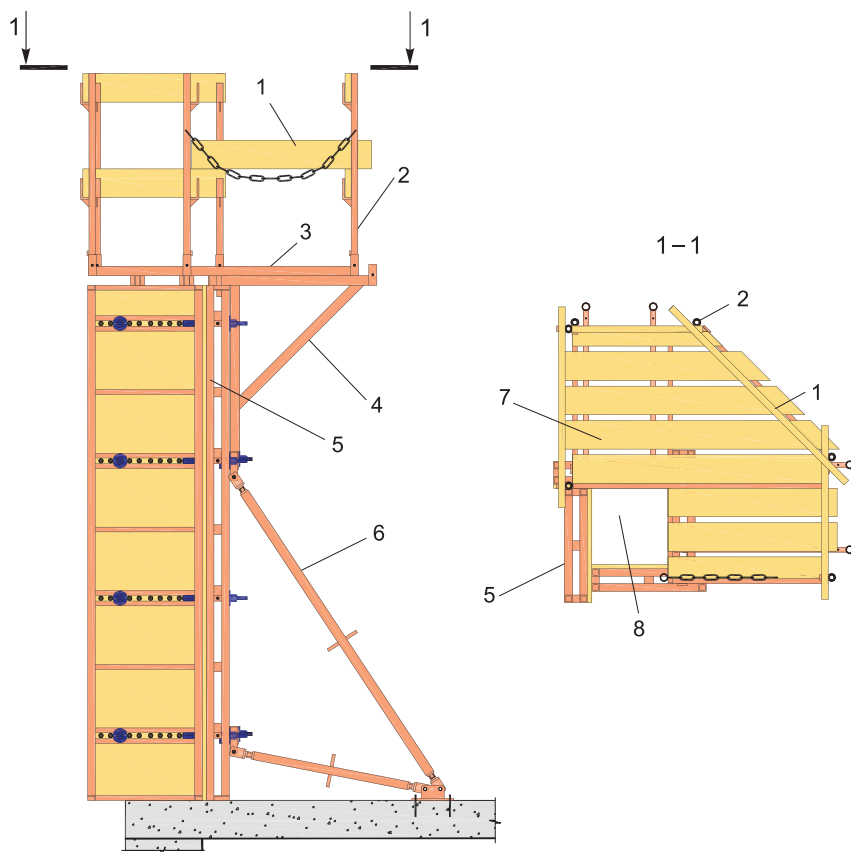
Схема установки навесных подмостей на опалубку колонн:
